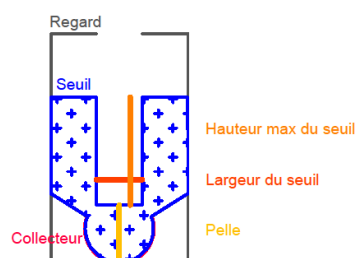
Schéma en coupe d'un regard équipé d'un seuil
